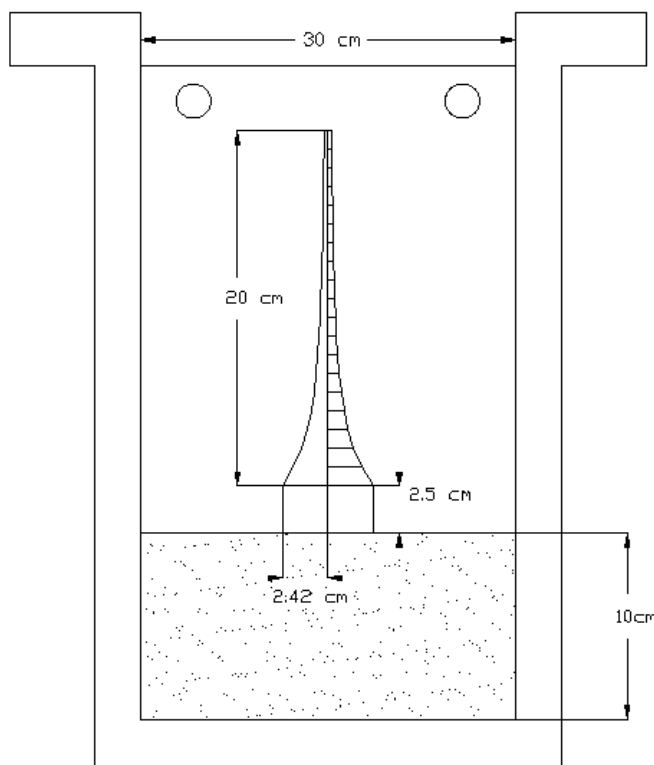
Tratamiento preliminar. Vista en Planta y lateral.
